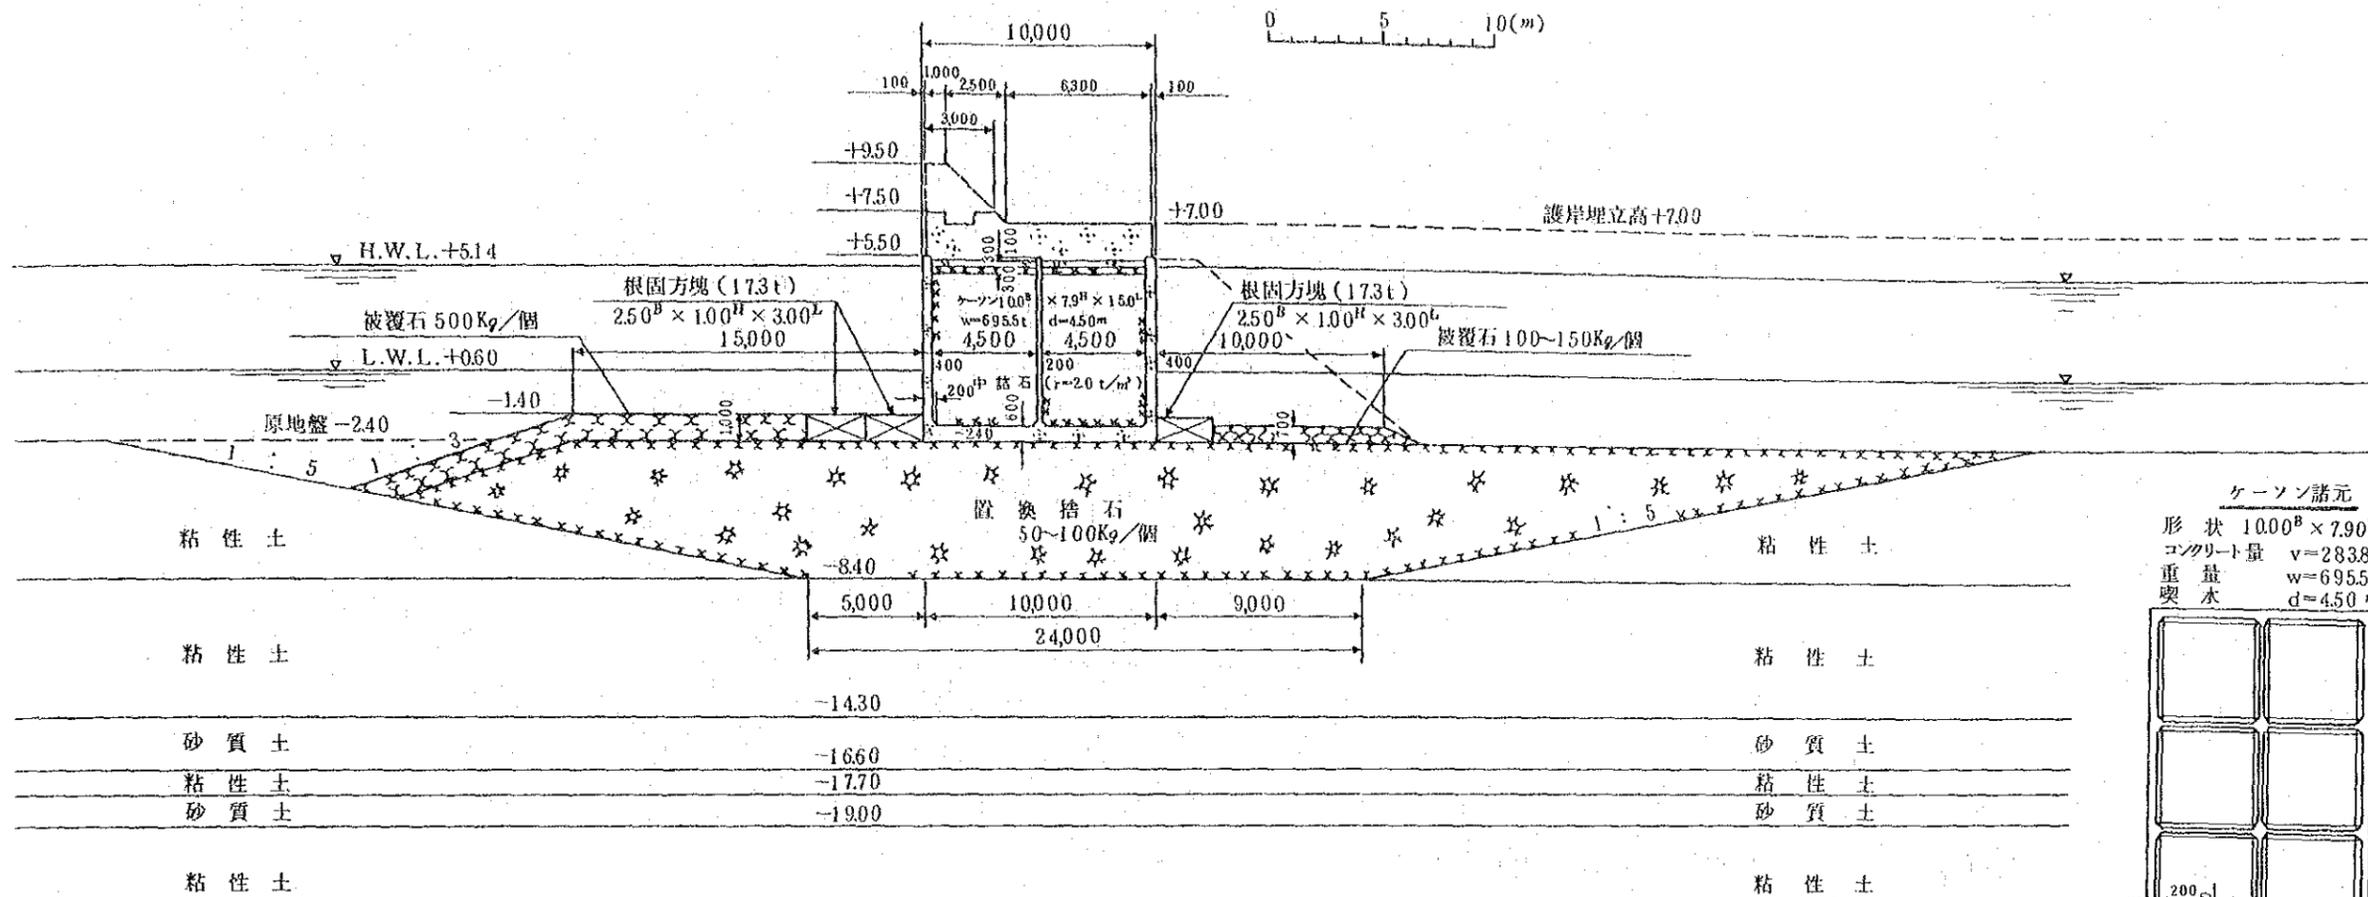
ケーソン式(床掘置換工法)標準断面図 比較案
